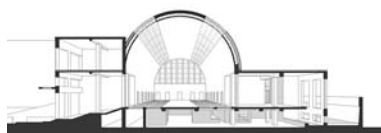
SANTANGELO B., *Progetto di restauro, spaccato prospettico
